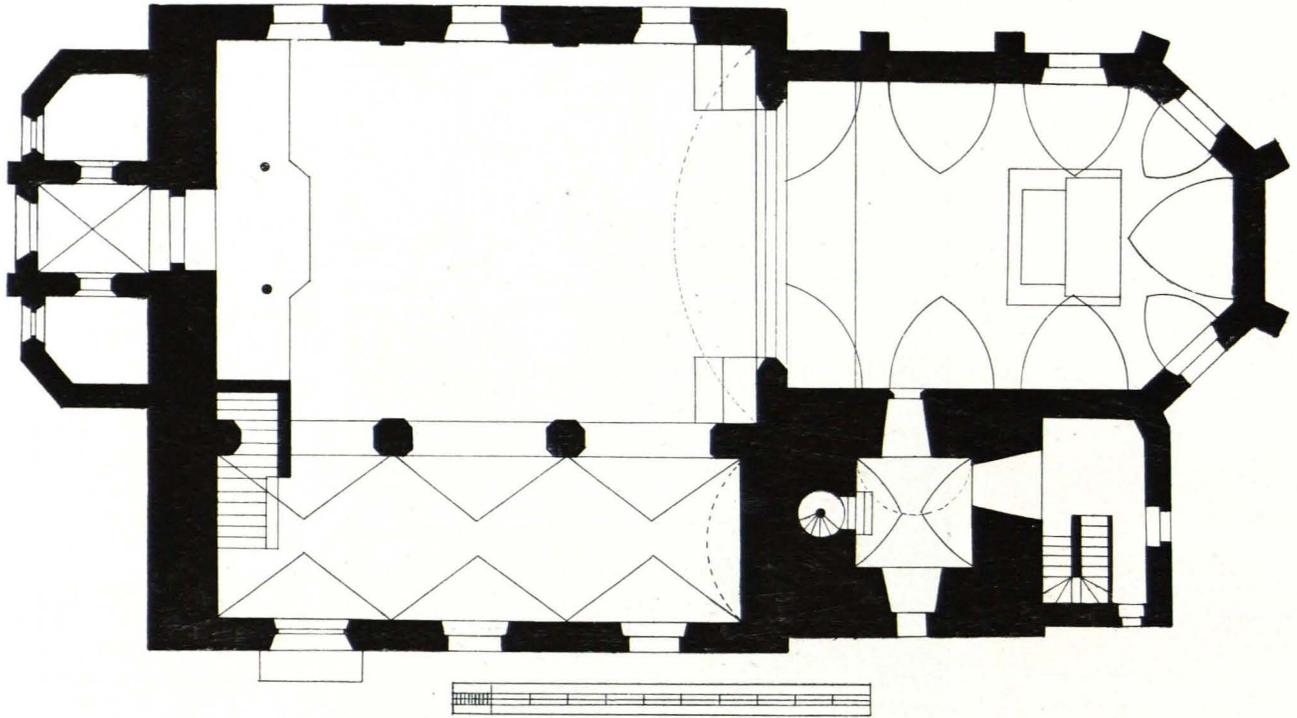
Grödig, Pfarrkirche, Grundriß 1:200 (S. 113)
